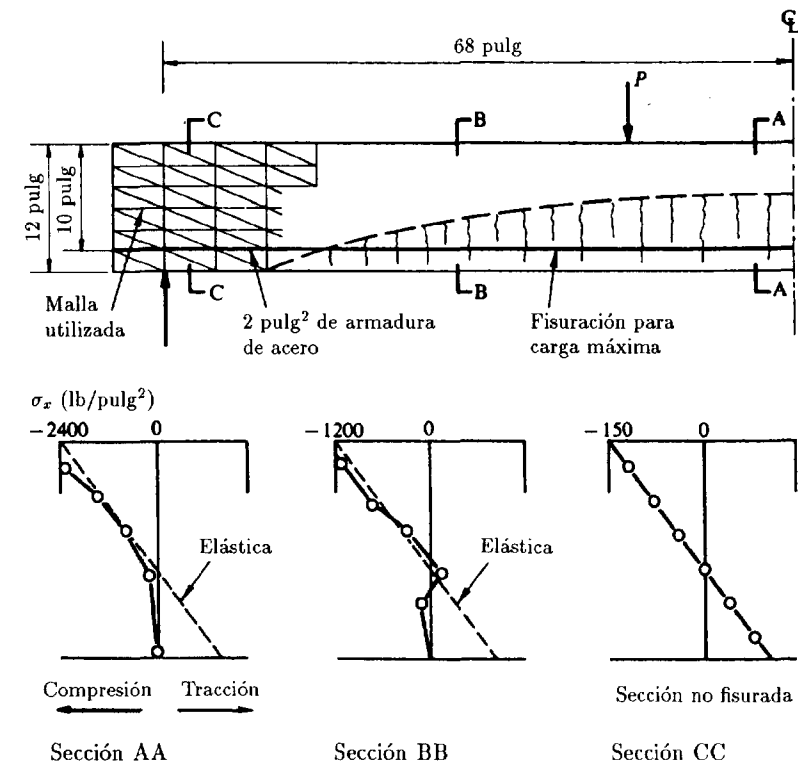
Fisuración de una viga de hormigón armado. (Tensión máxima de tracción 200 lb/pulg²). Distribución de las tensiones del hormigón en varias secciones.¹¹⁹
